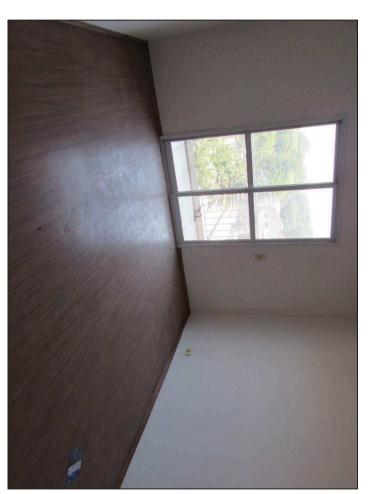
Vista as sala pertencente ao apartamento nº 82, piso laminado.
